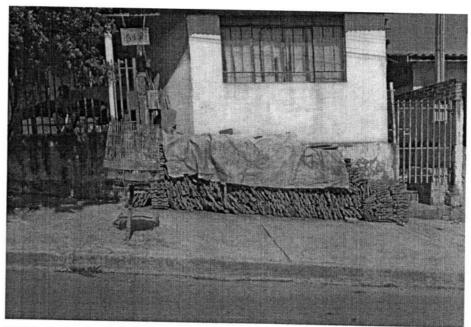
Depósito de materiais para a construção em local inadequado – Jd. Bela Manhã FONTE: GASINI
